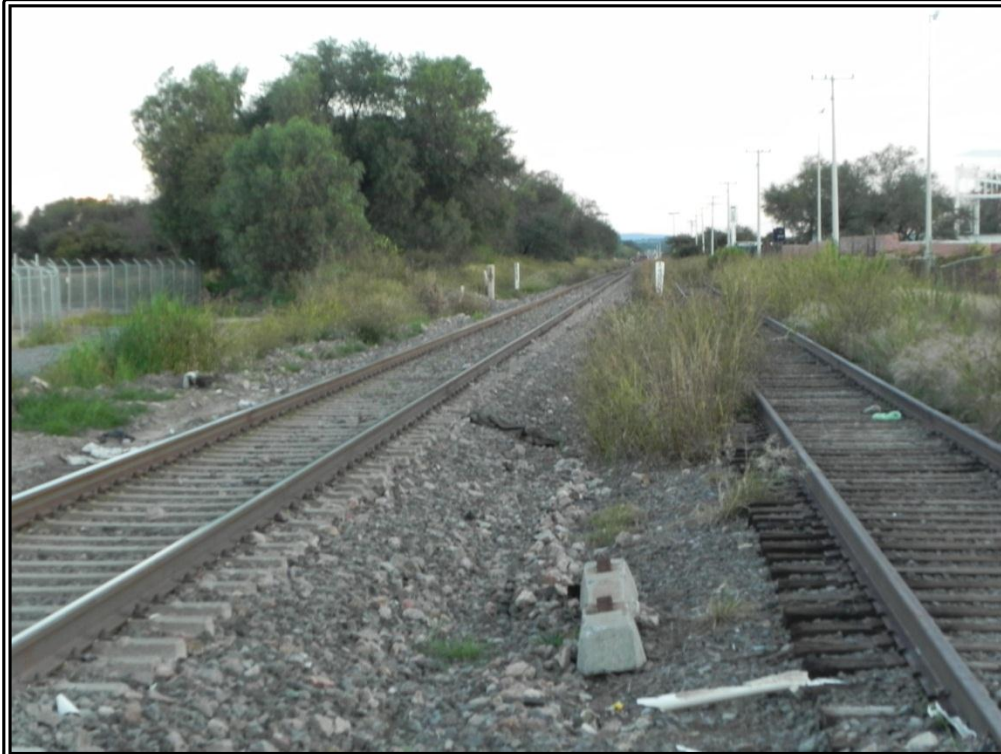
Cruce direccional de vías de ferrocarril.
